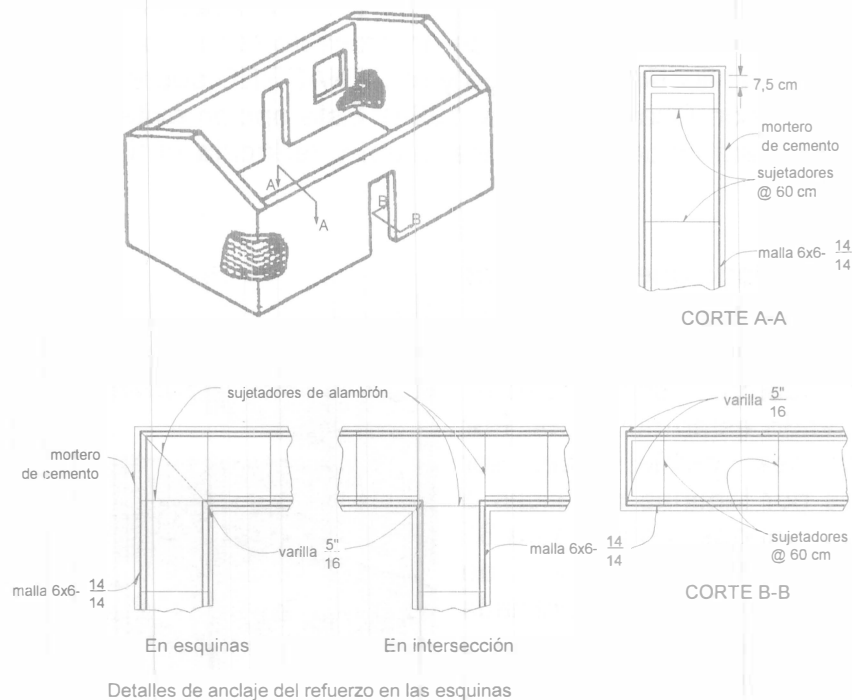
Encamisado de muros de adobe con mallas metálicas recubiertas con mortero.
